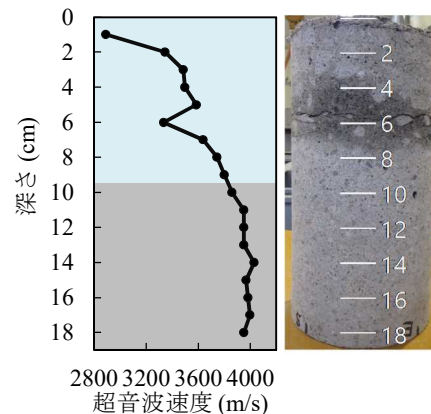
採取コアの超音波速度と水平ひび割れの状況
